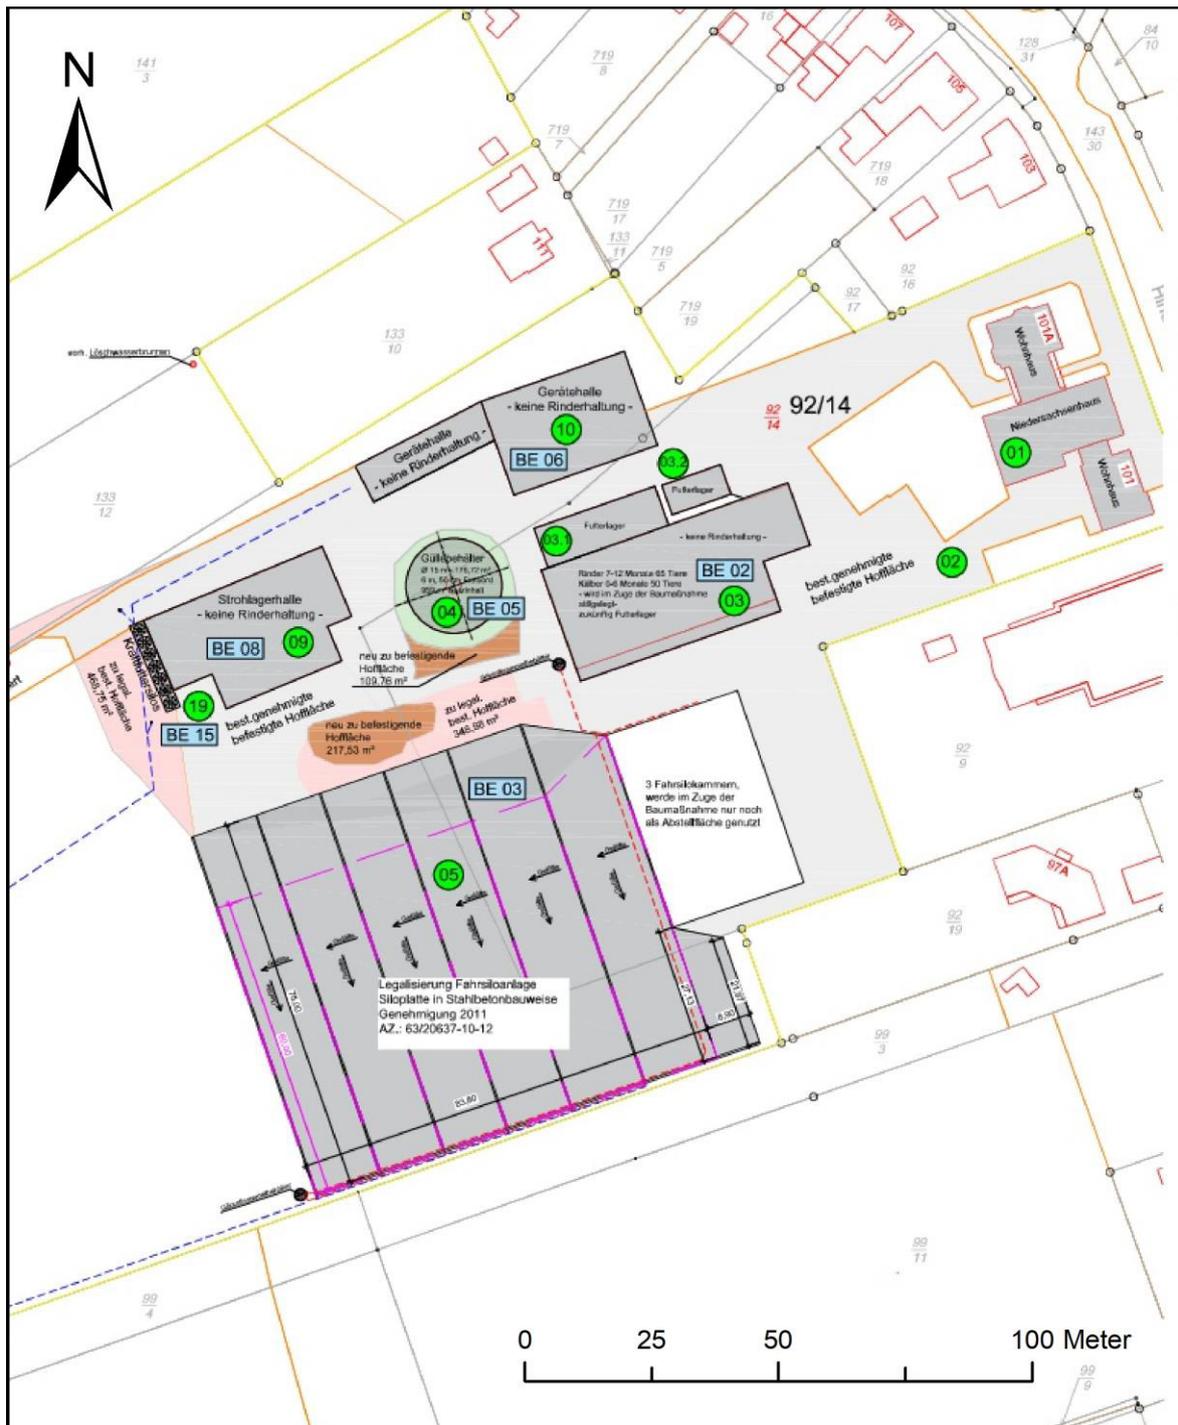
Übersicht über den zukünftigen Gesamtbetrieb (Gebäude dunkelgrau, Verkehrsflächen genehmigt hellgrau, zu legalisieren rosa) und die geplanten Erweiterungen (farbige Flächendarstellung) von Herrn Reiner Garms. Lageplan vom 18.2.2021, erstellt durch BILLIGEN INGENIEUR- & PLANUNGSBÜRO in 54552 Dreis-Brück. M 1 : 4.000.
